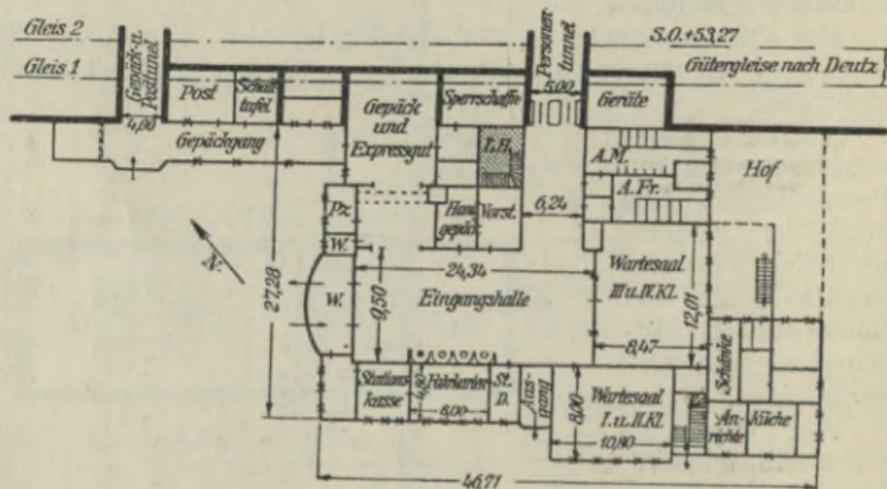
Grundriß des Erdgeschosses des Empfangsgebäudes Köln-Kalk (Kalk-Süd). M. 1 : 1000.
